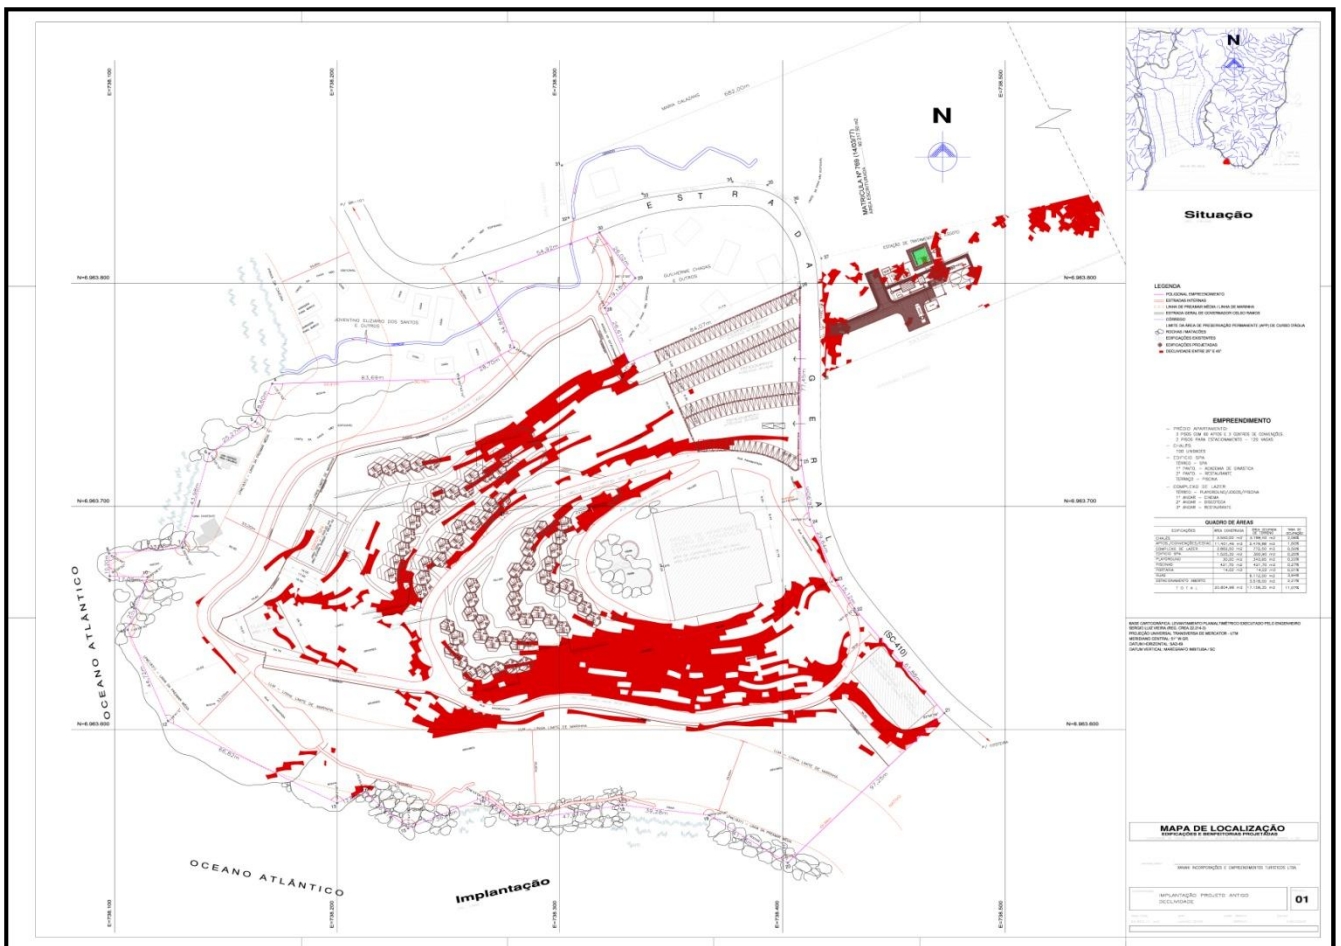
Planta do Projeto Xanahi Magic Resort e ETE sobreposta as manchas de declividade entre 25° e 45° (Planta antiga).
